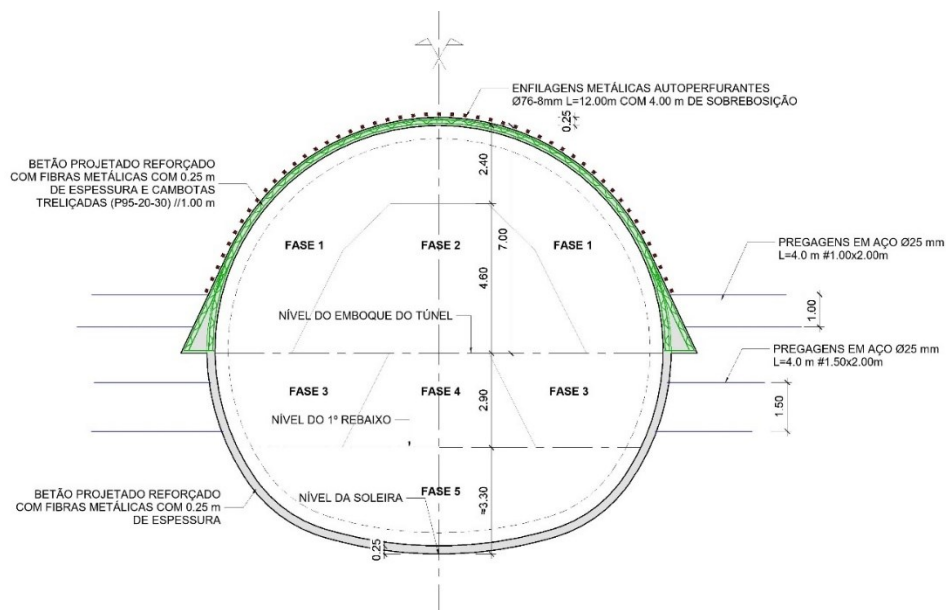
Corte transversal da secção 1 do túnel de ligação.
